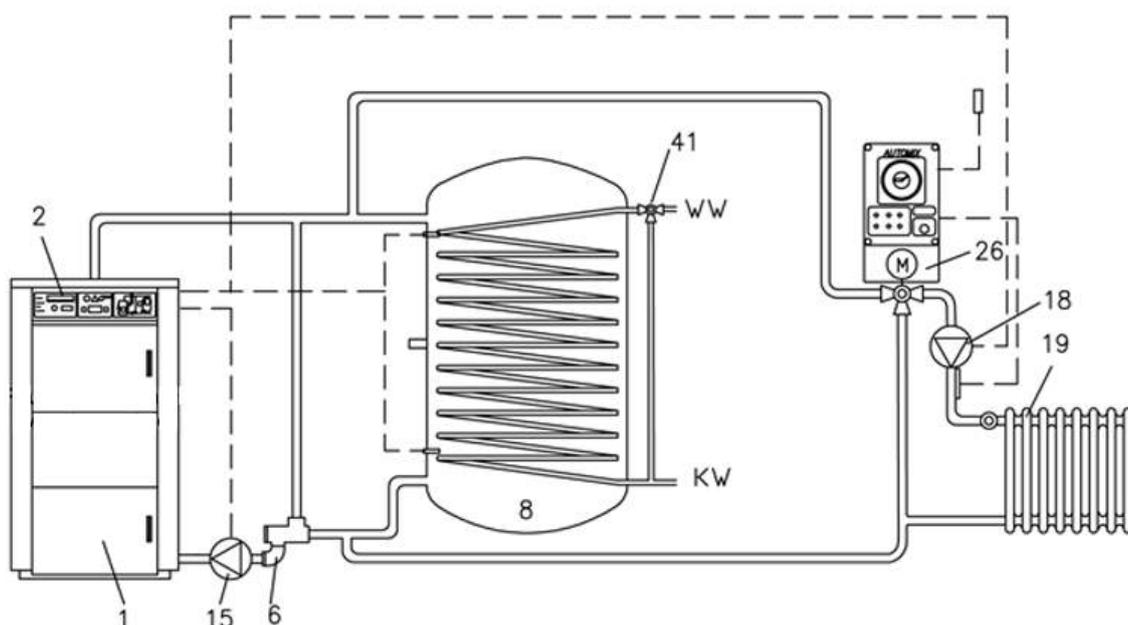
Anlagenvorschlag A Bild 1: Holzheizungsanlage mit Kombipuffer
